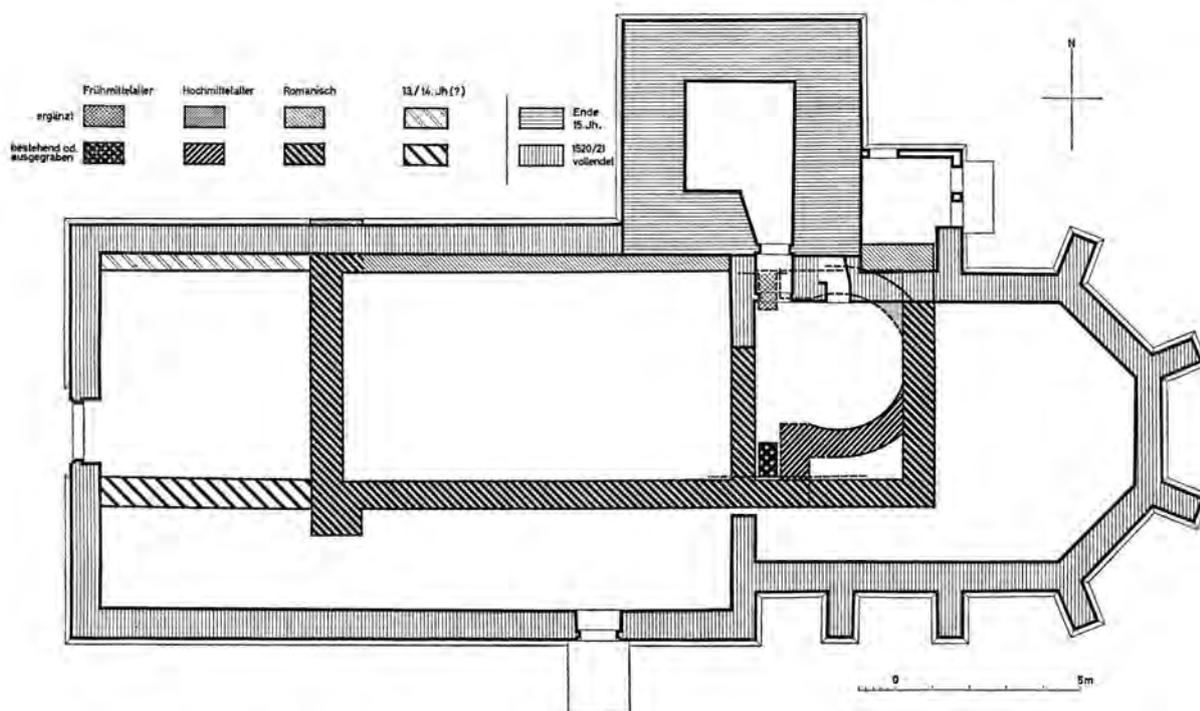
Mettmensstetten ZH, Kirche. Bauetappenplan. – 1:200.
